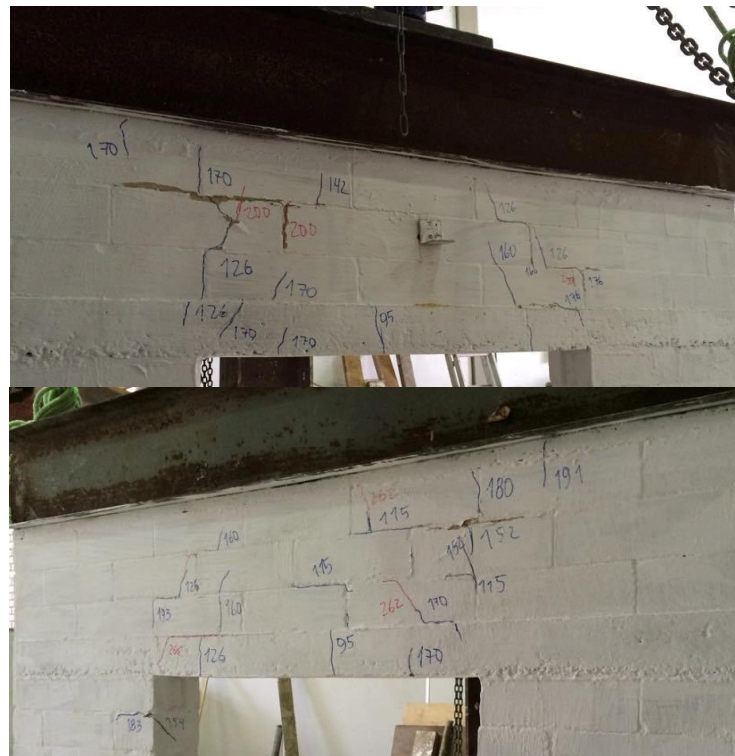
Fissuras observadas na região superior da Parede 2.
